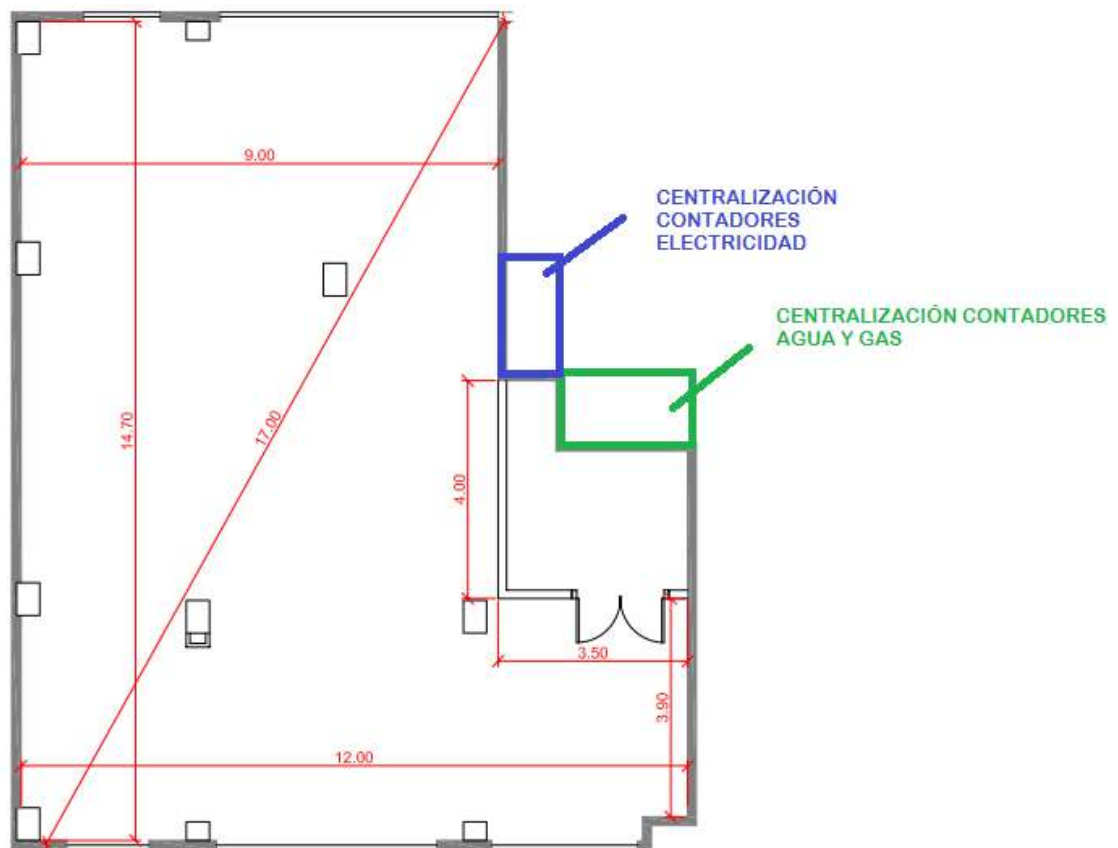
"Planta estado actual del local". Fuente: Proyecto construcción
